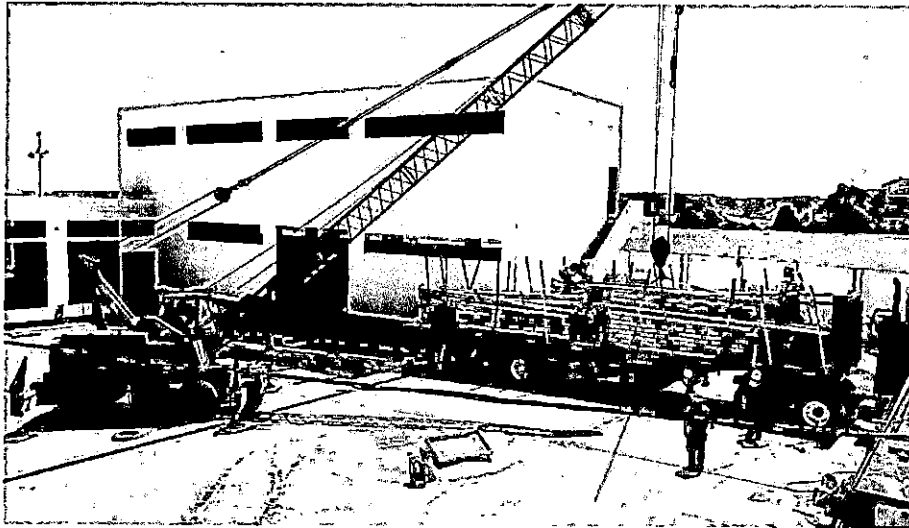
Descarga de la estructura metálica en patio de maniobras del DPA.
